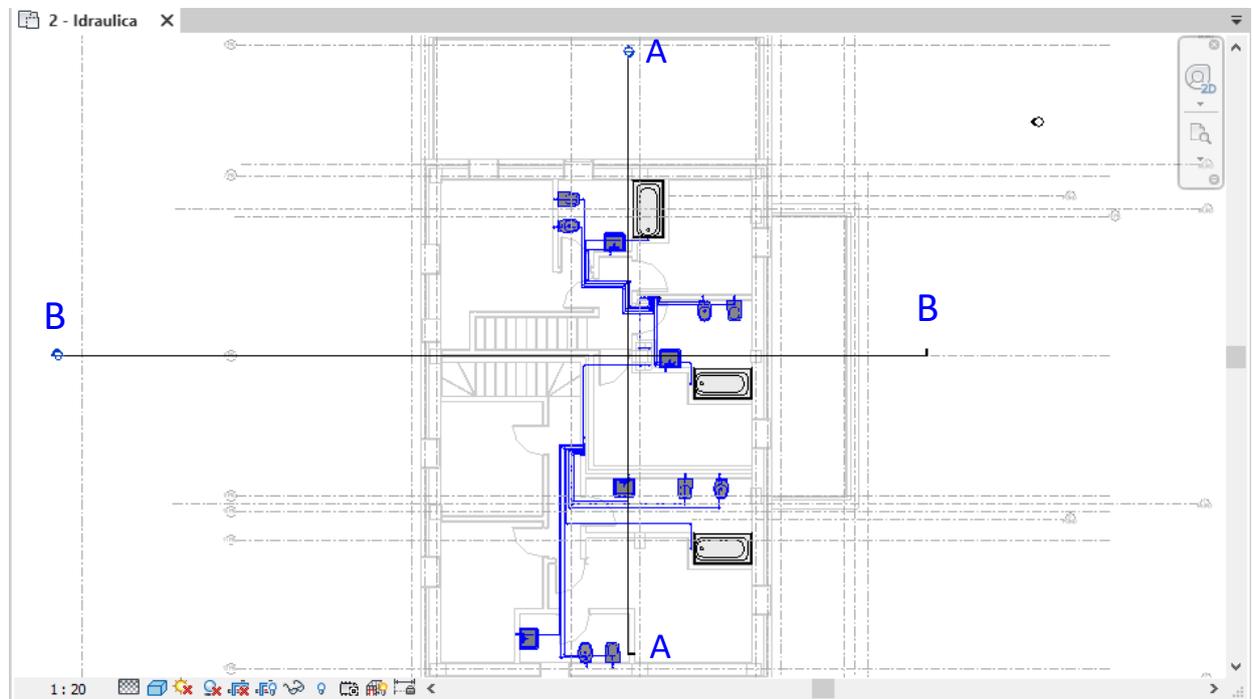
Vista 2-Idraulica: Pianta piano primo
